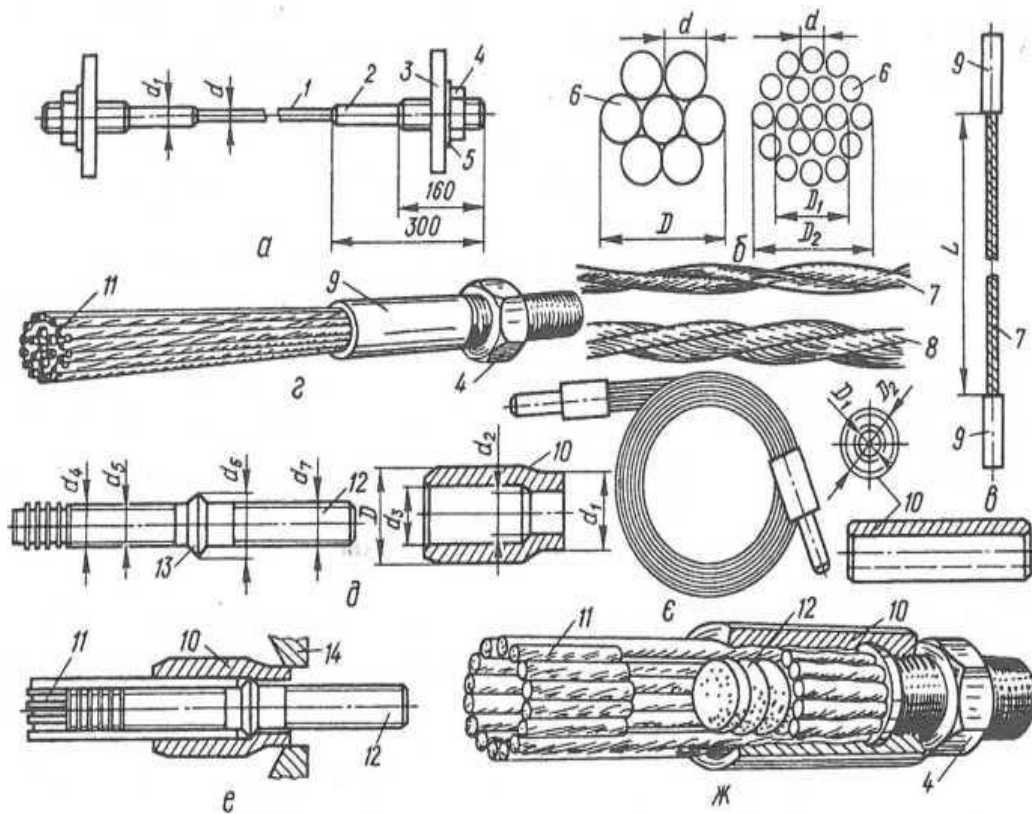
Заготівля напружуваних арматурних елементів: *а* — арматурний стрижень з нарізкою на кінцях; *б* — арматурні пасма і канати; *в* — арматурне пасмо з опресованими гільзами; *г* — загальний вид арматурного пучка з гільзовим анкером; *д* — деталі гільзострижневого анкера; *е* — те саме, для опресування; *є* — пучок, підготовлений для відправлення; *ж* — гільзострижневий анкер з пучком дроту після опресування; 1 — стрижнева арматура; 2 — оцупок з нарізкою на кінці; 3 — плита; 4 — гайка; 5 — шайба; 6 — дровові пасма; 7 — канат з двох 19-дротових пасом; 8 — те саме, з двох 7-дротових пасом; 9 — гільза; 10 — те саме, в розрізі; 11 — дротини пучка; 12 — анкерний стрижень; 13 — бурт; 14 — фільєра
